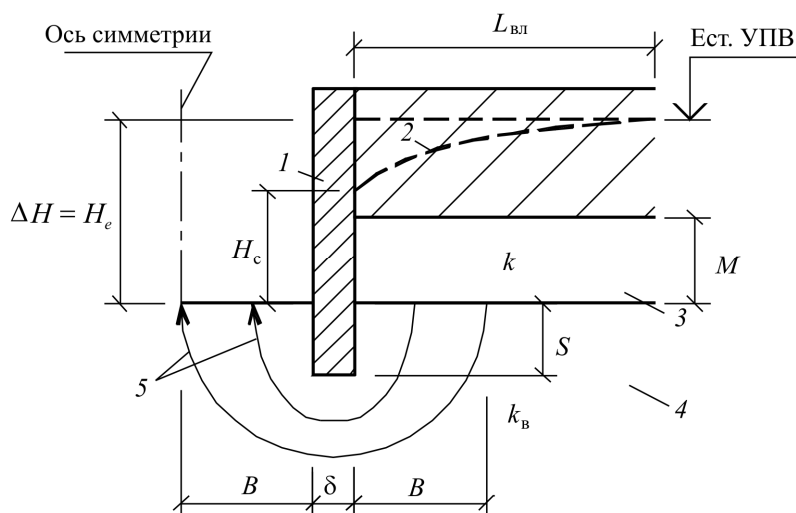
Расчетная схема 2: 1 – непроницаемая стенка; 2 – пониженный уровень подземных вод; 3 – водоносный пласт; 4 – проницаемый грунт (относительный водоупор); 5 – движение подземных вод в сторону выработки
